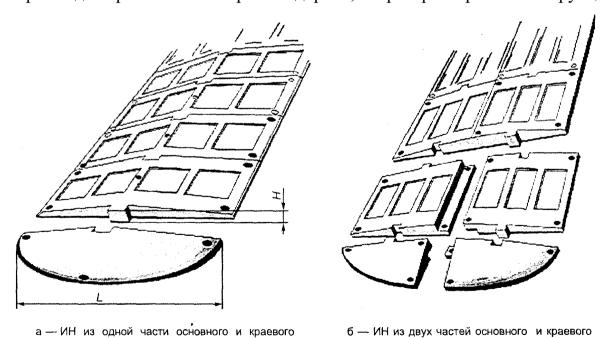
Конструкция сборно-разборной искусственной дорожной неровности
